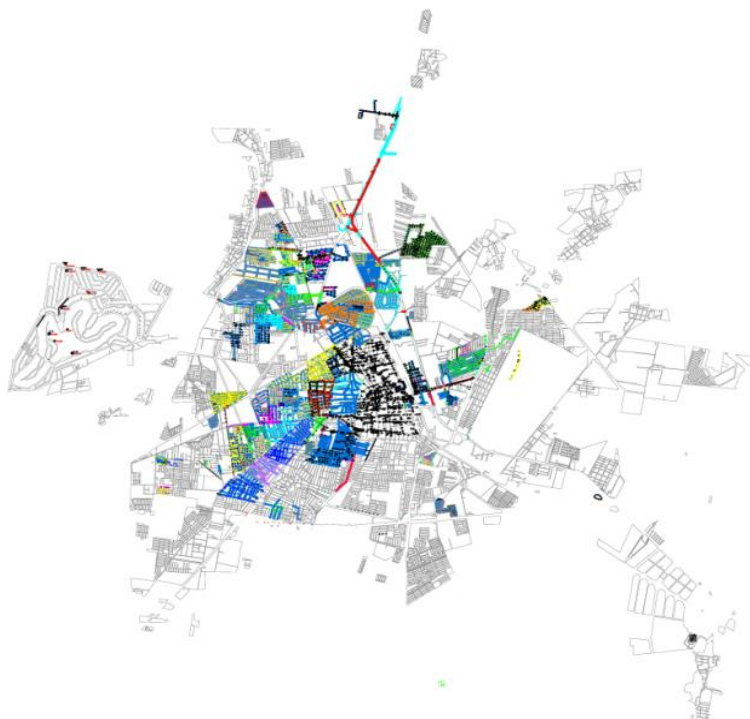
Plano de la red de drenaje sanitario y alcantarillado.
